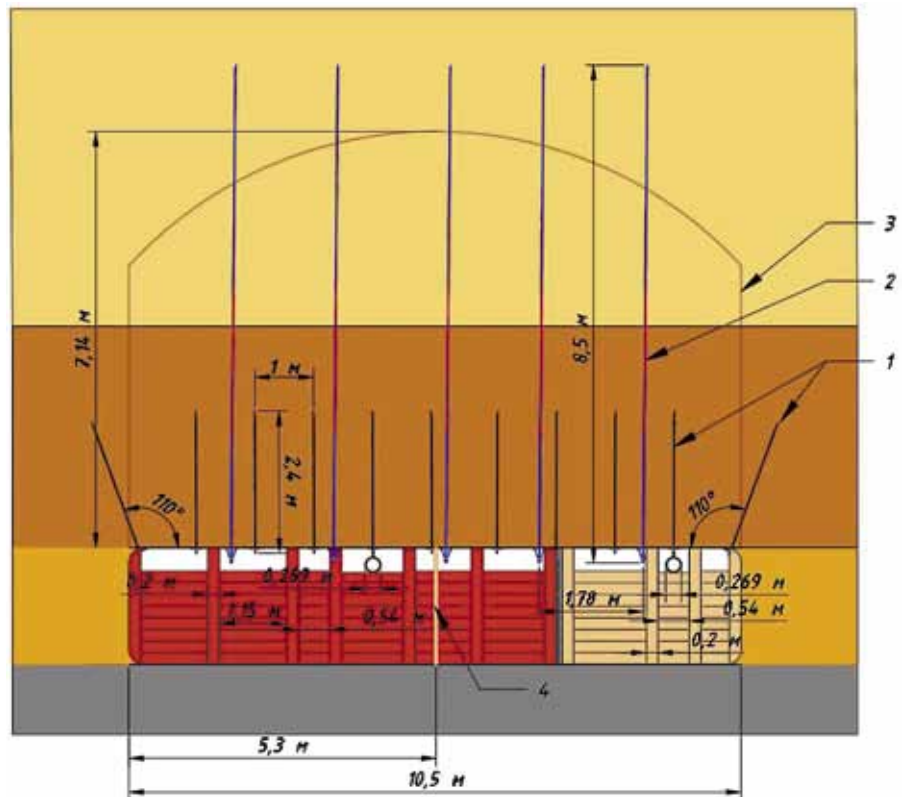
Поперечное сечение проводимой закладочной выработки: 1 – анкерная крепь 1-го уровня; 2 – анкерная крепь 2-го уровня; 3 – зона свода естественного равновесия; 4 – стойки крепи усиления
